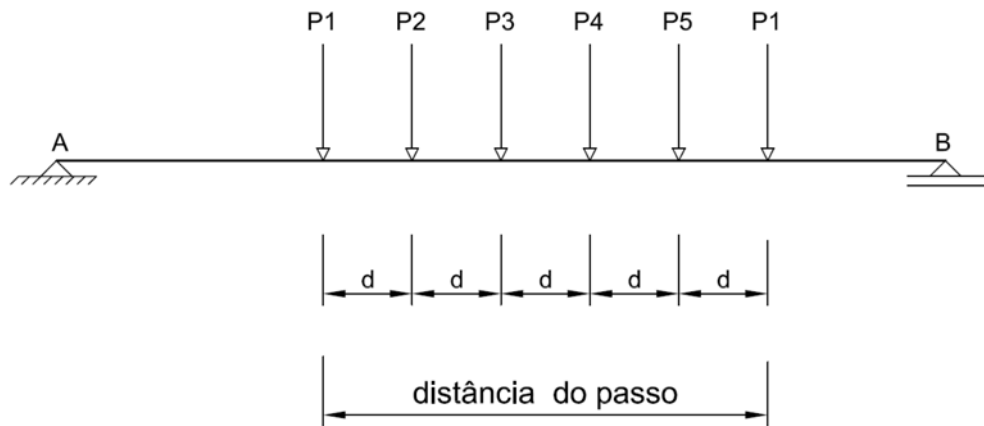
Aplicação da ação dinâmica sobre a estrutura.
